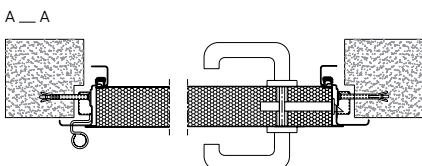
Horizontalschnitt Stahlaußentüren ECO mit Eckzarge
